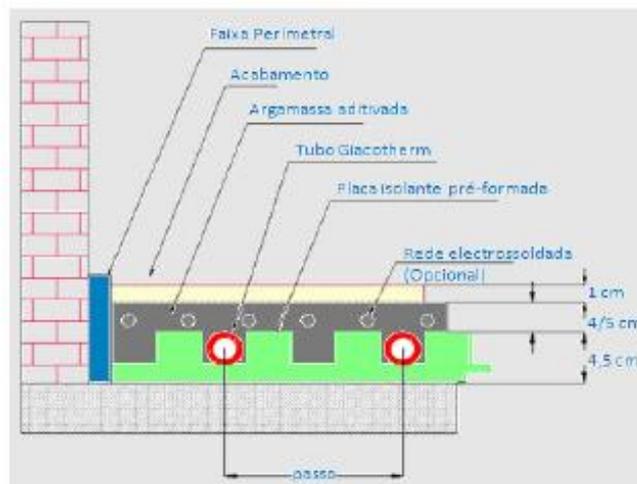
Composição do pavimento radiante "molhado", Fabricante: Giacomini
